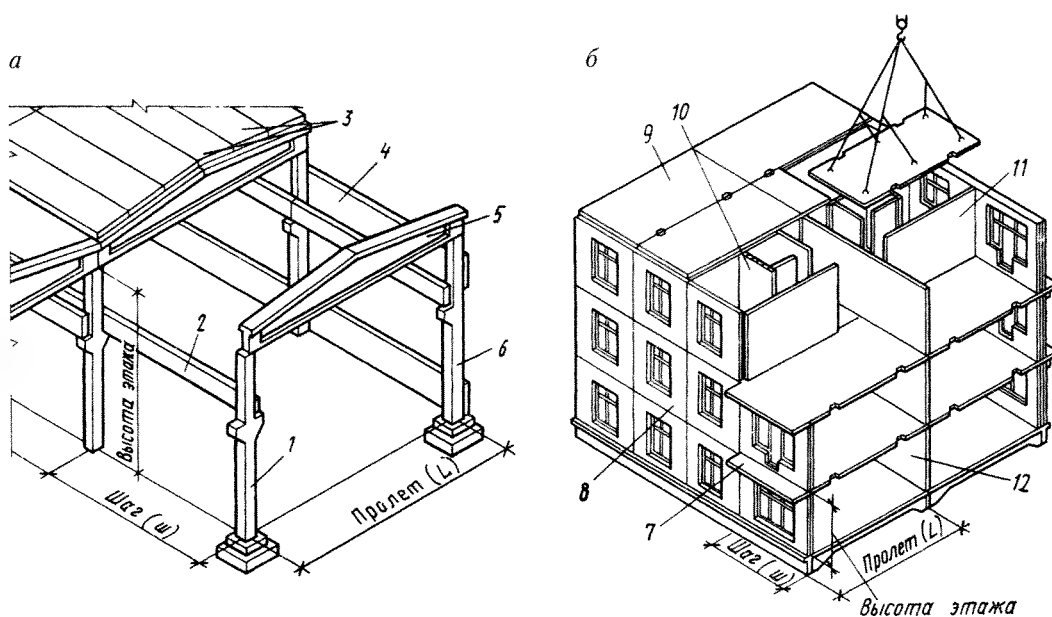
Типовые конструктивные элементы зданий; параметры зданий:
